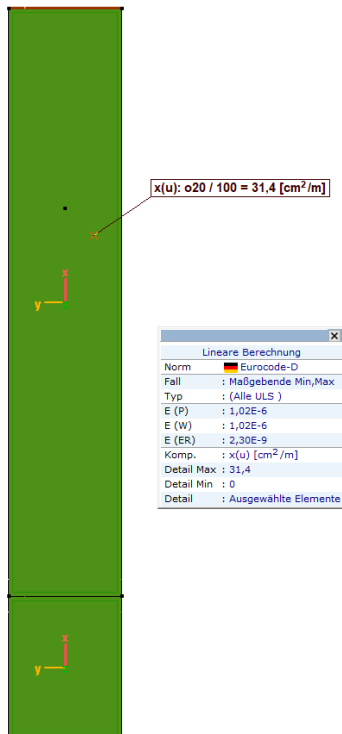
Innere Wand, Randzone, gewählte Bewehrung vertikal (links und rechts)
